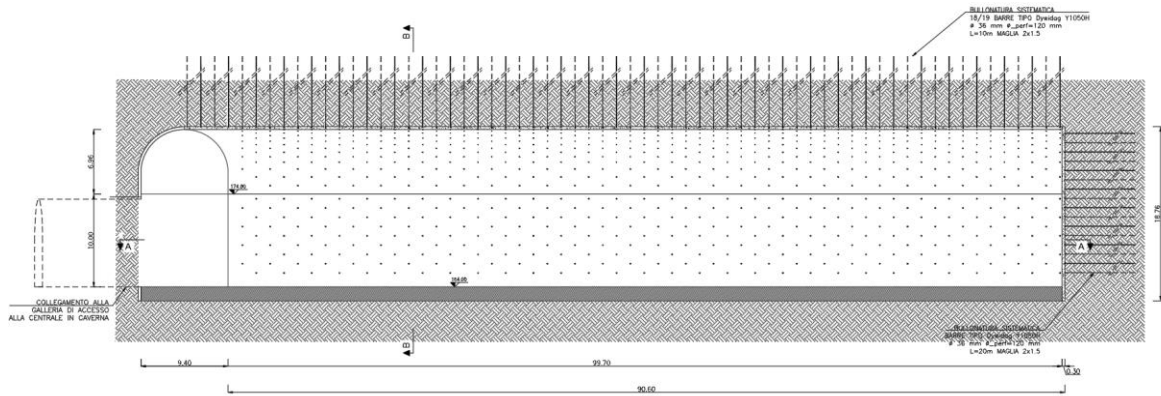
Sottostazione elettrica, sezione longitudinale
